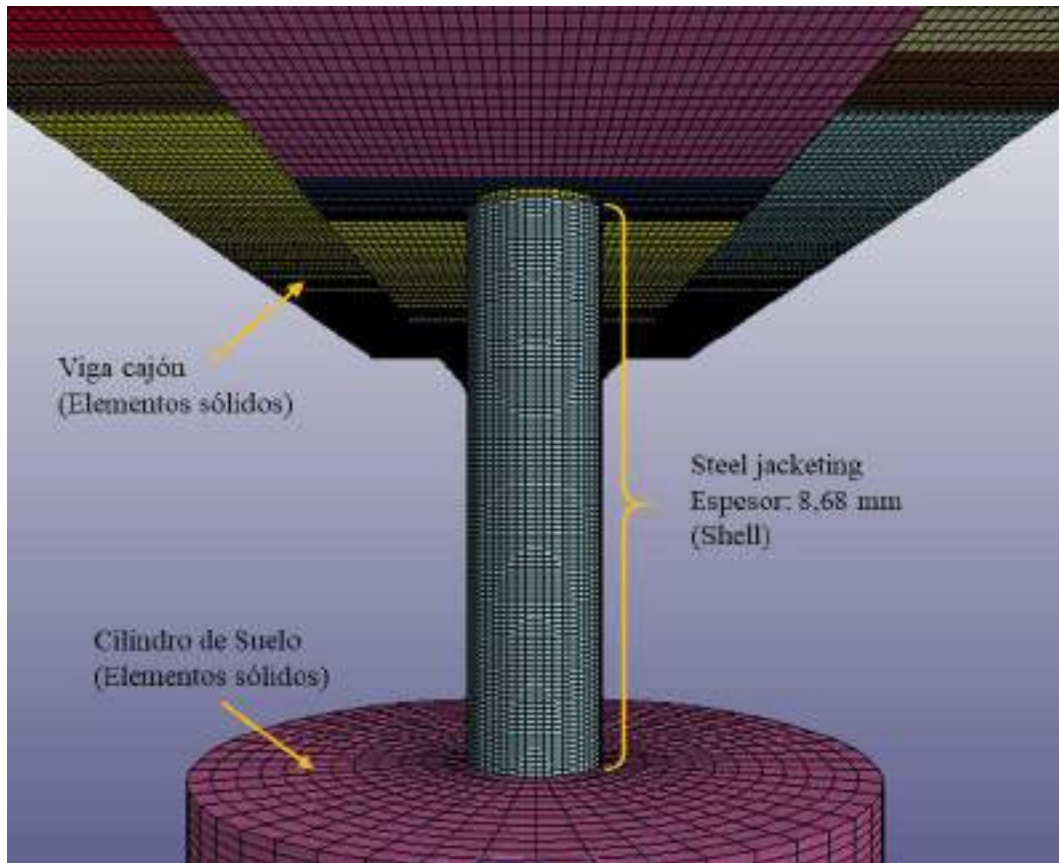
Modelo numérico de puente Boedo reforzado con encamisado metálico.
